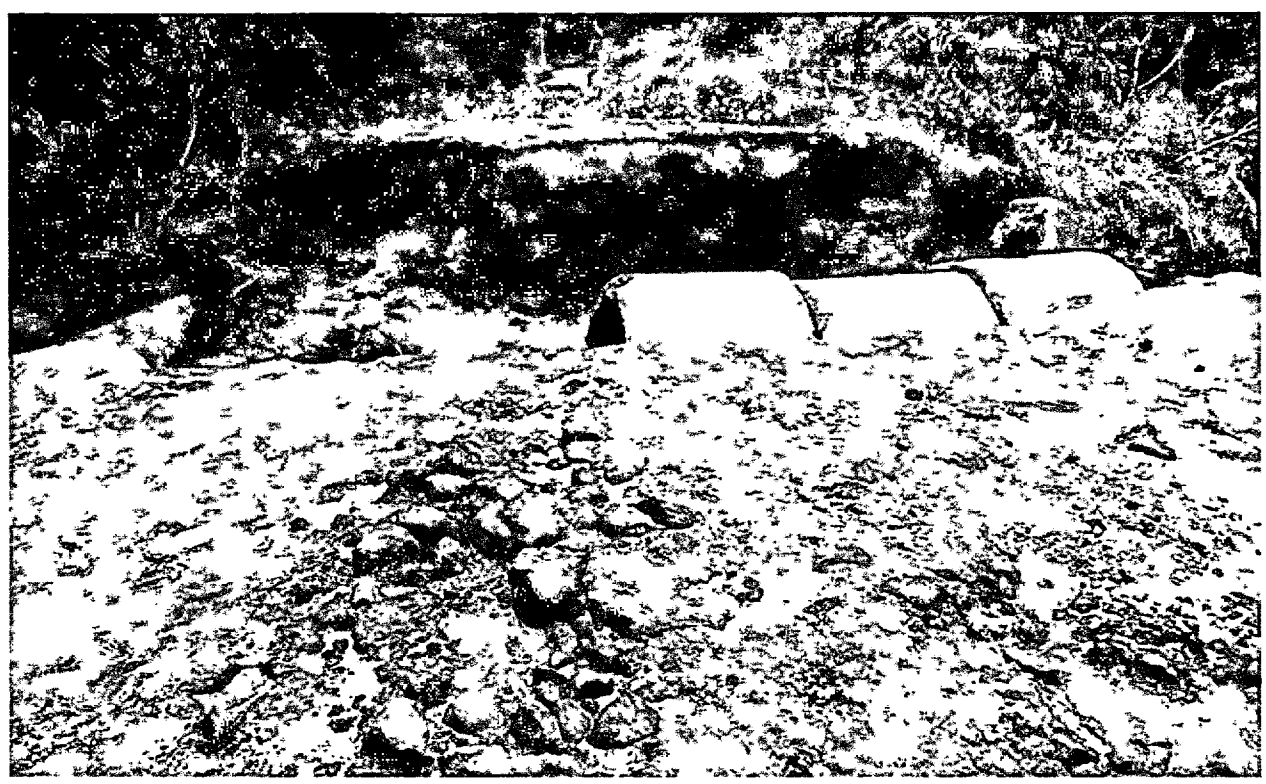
Bueiro destruído, necessitando a construção de bueiro, Povoado São Gonçalo, dia 20/03/2020, Coordenadas: (Latitude: 3°27'37.64"S; Longitude: 43° 2'53.88"O; Altitude: 81m)
